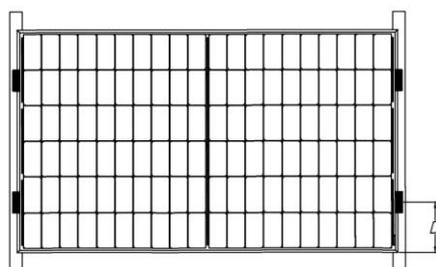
Направляющие, перекрывающие короткую сторону корпуса
